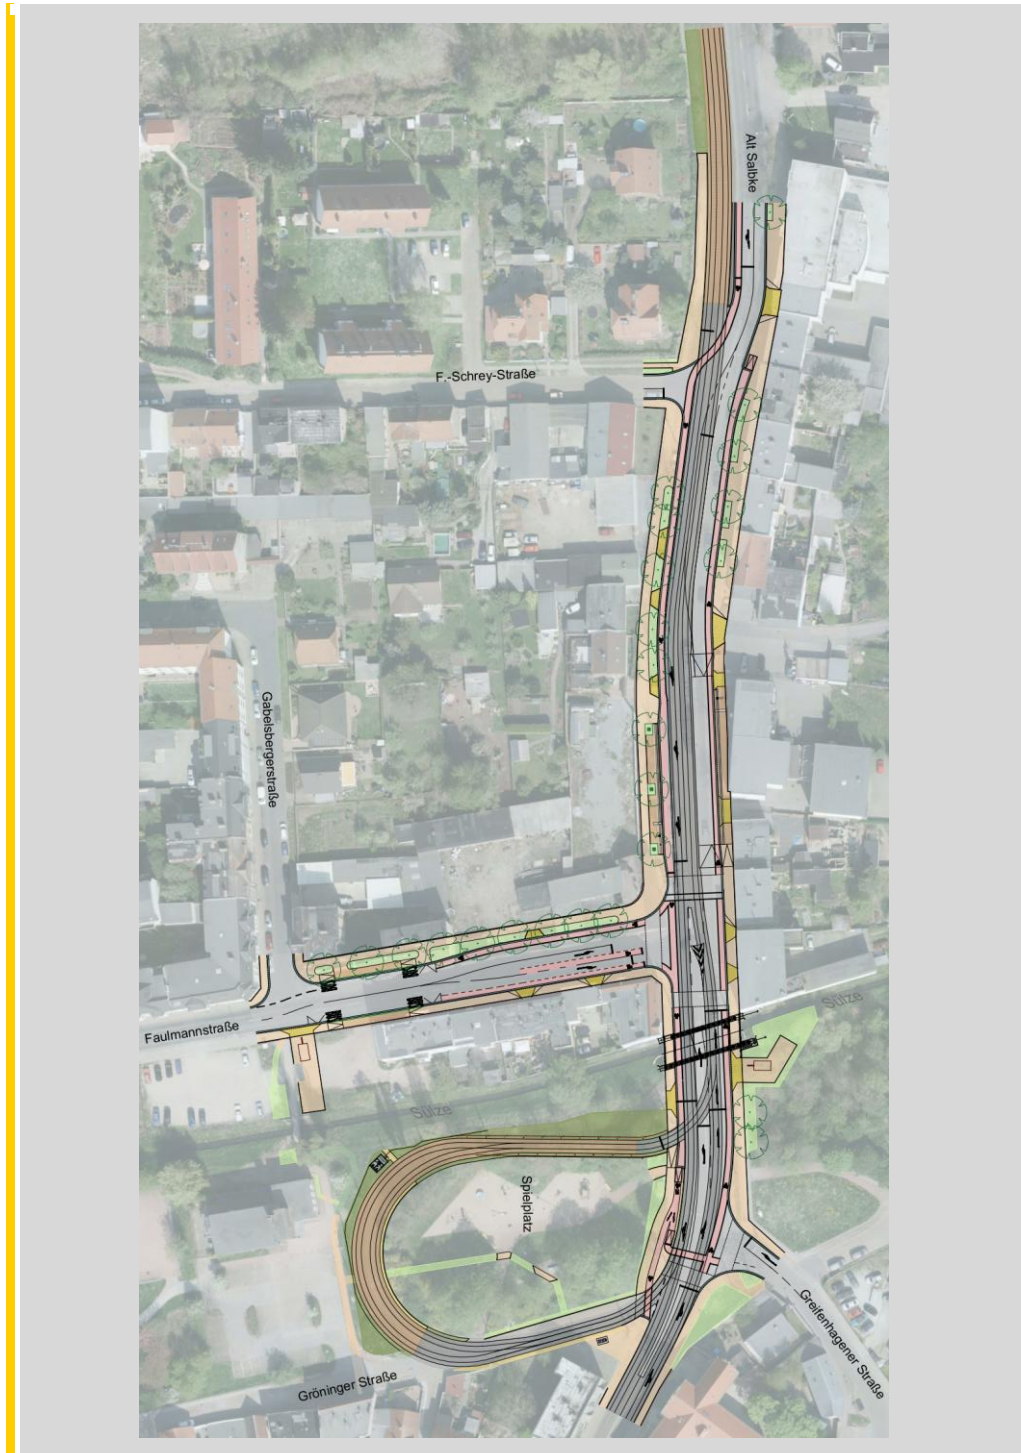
Übersichtslageplan - Ausbau Knoten Faulmannstraße
